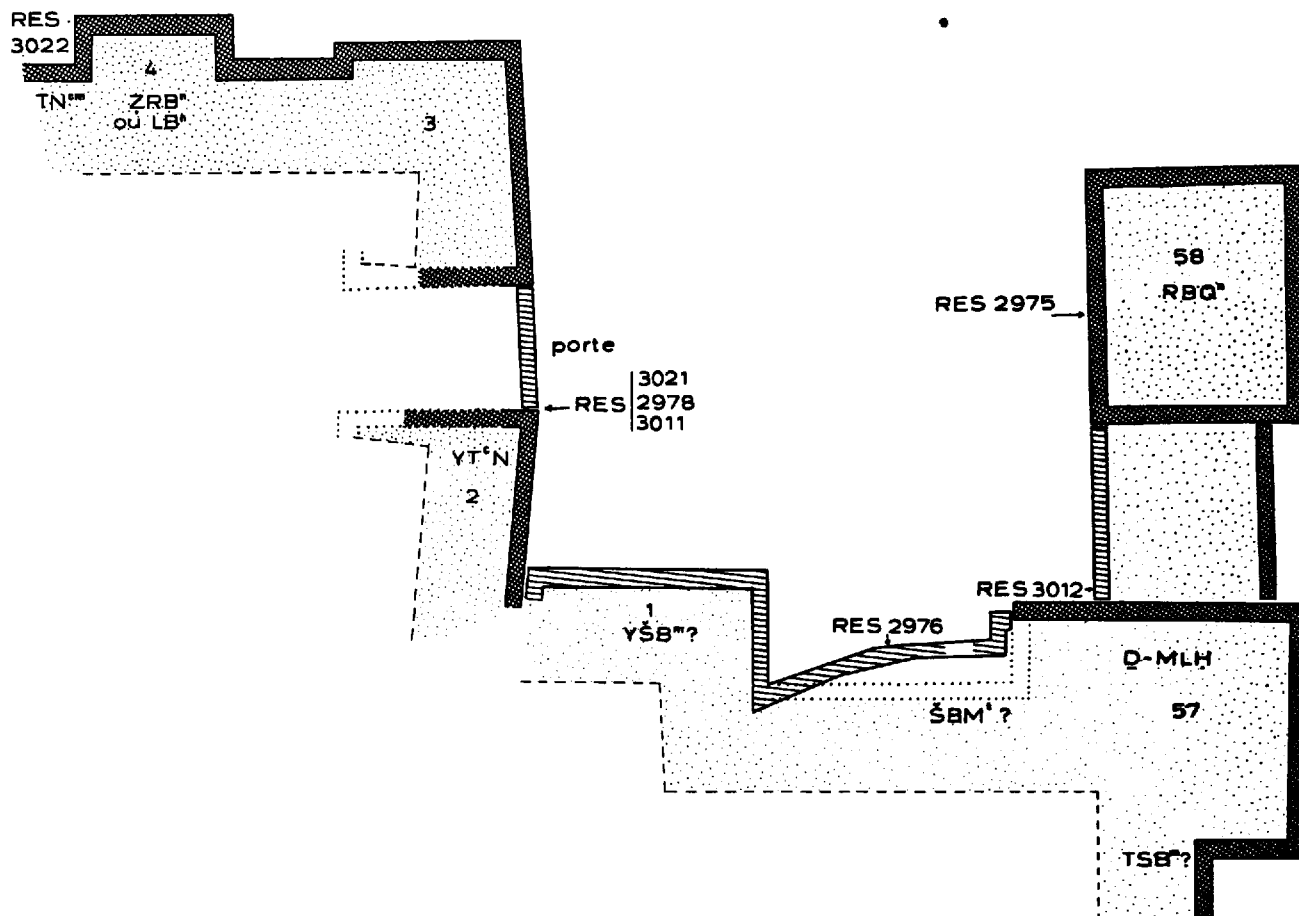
Barâqîš: plan de la porte sud-ouest.
